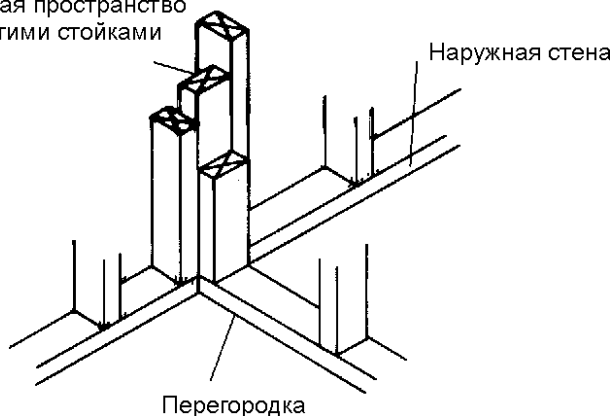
Третий способ крепления перегородок к наружным стенам
